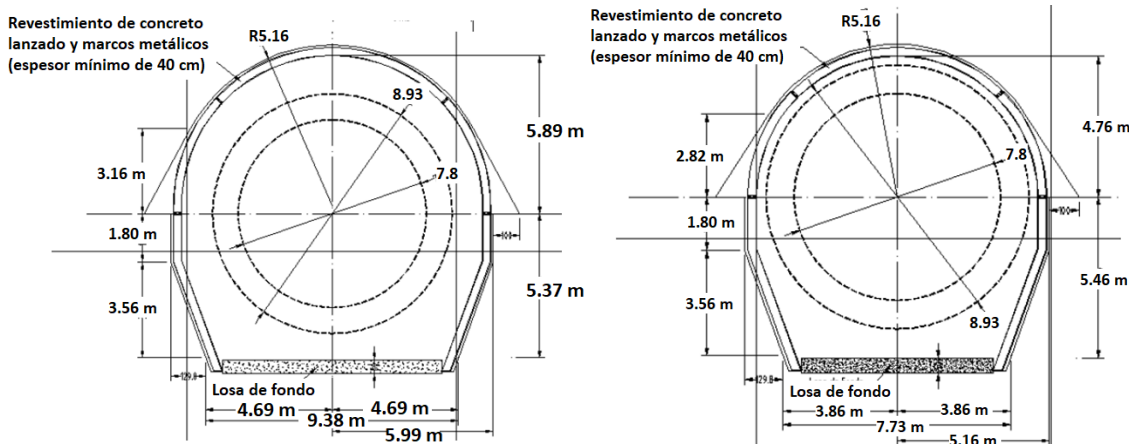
Geometría de la Sección y Sección 2 de la galería respectivamente.
